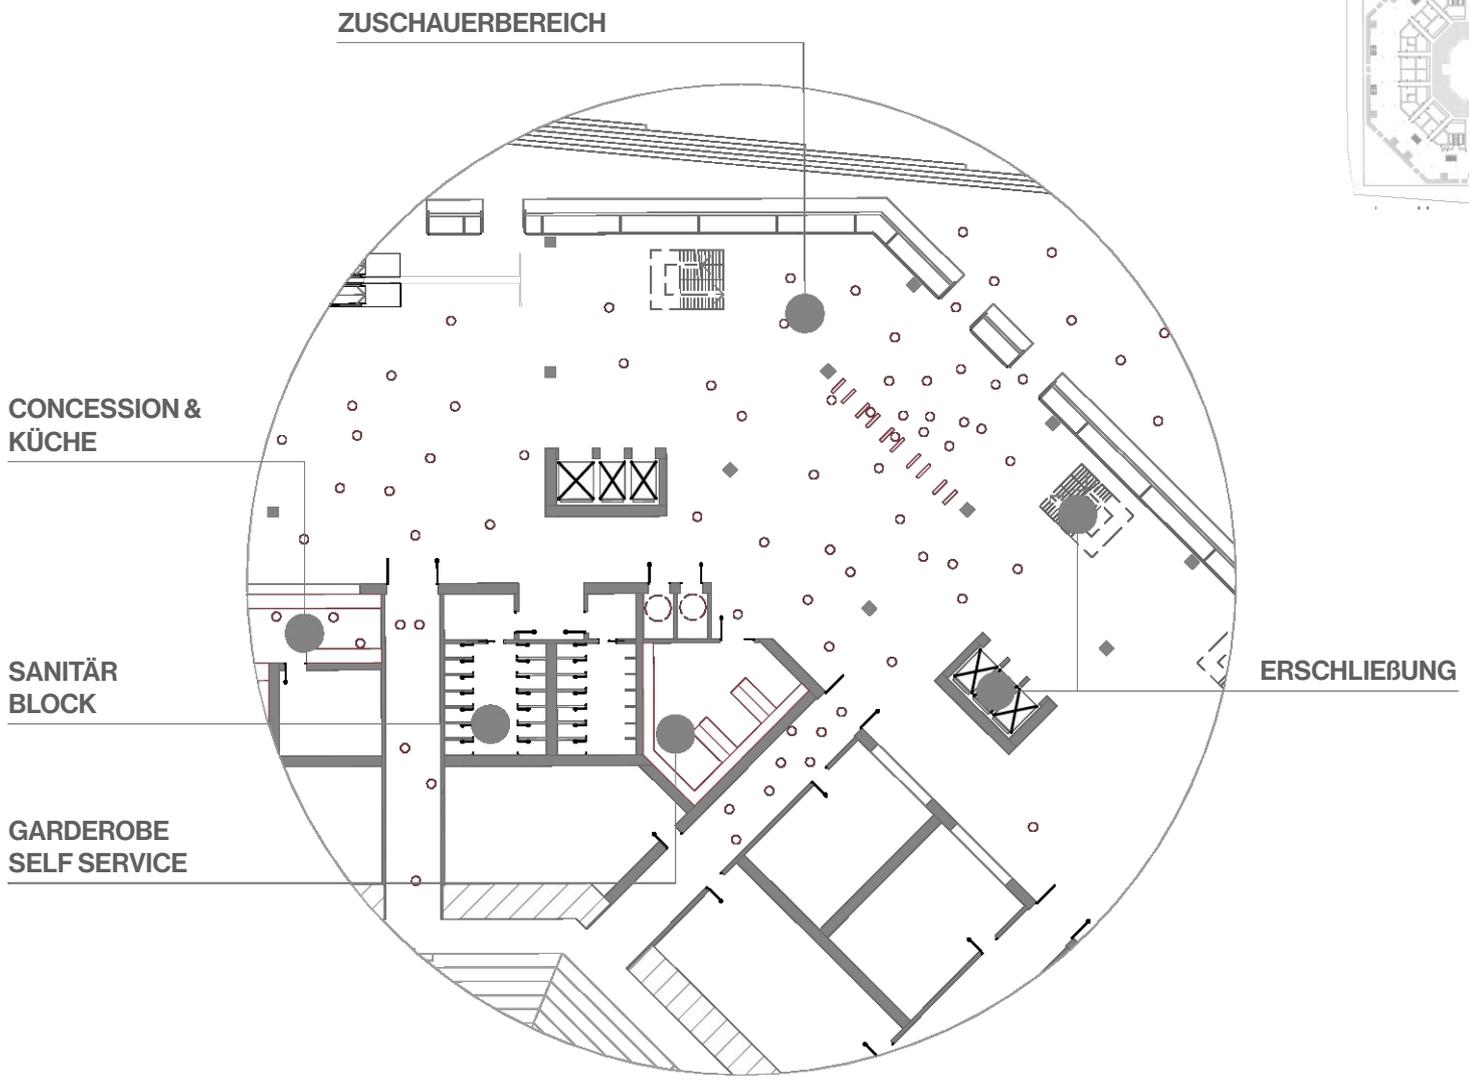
Grundriss 1. OG Zoom Concessions
